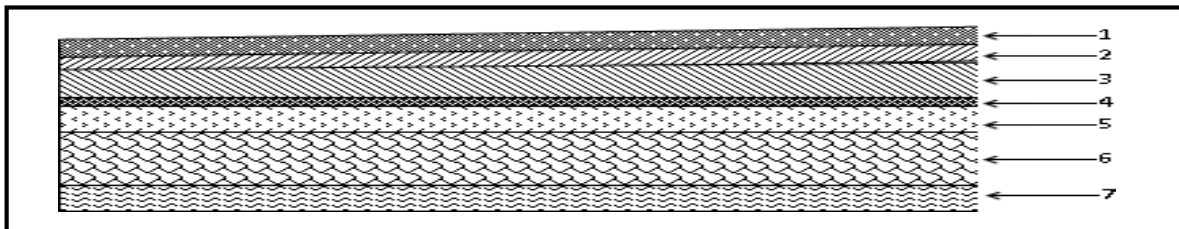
Coupe transversale du plancher terrasse inaccessible.
